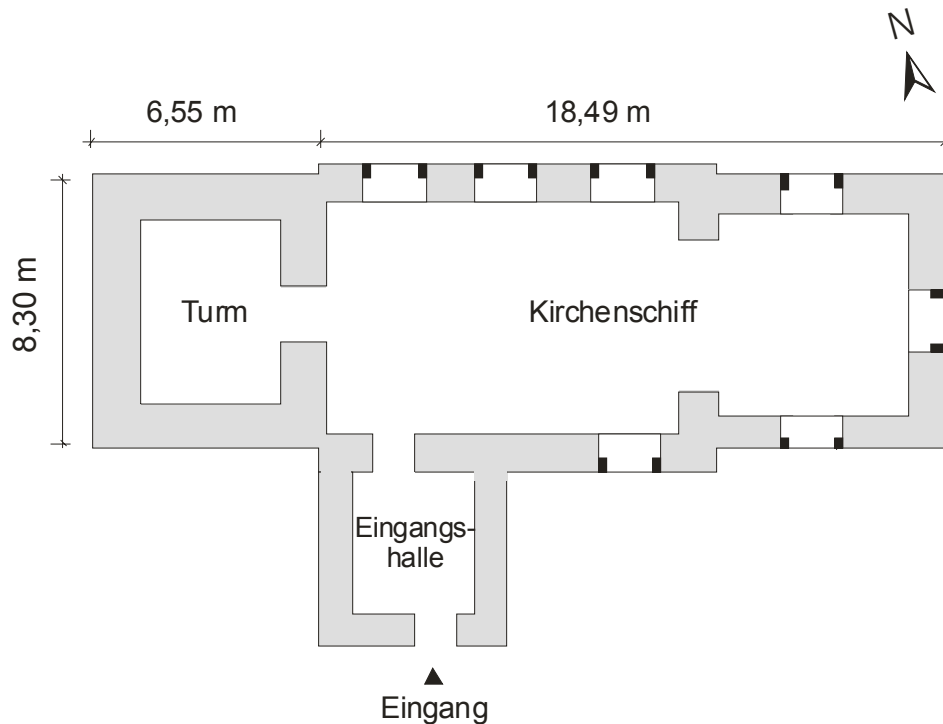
Der Grundriss des Kirchengebäudes in Uehrde
